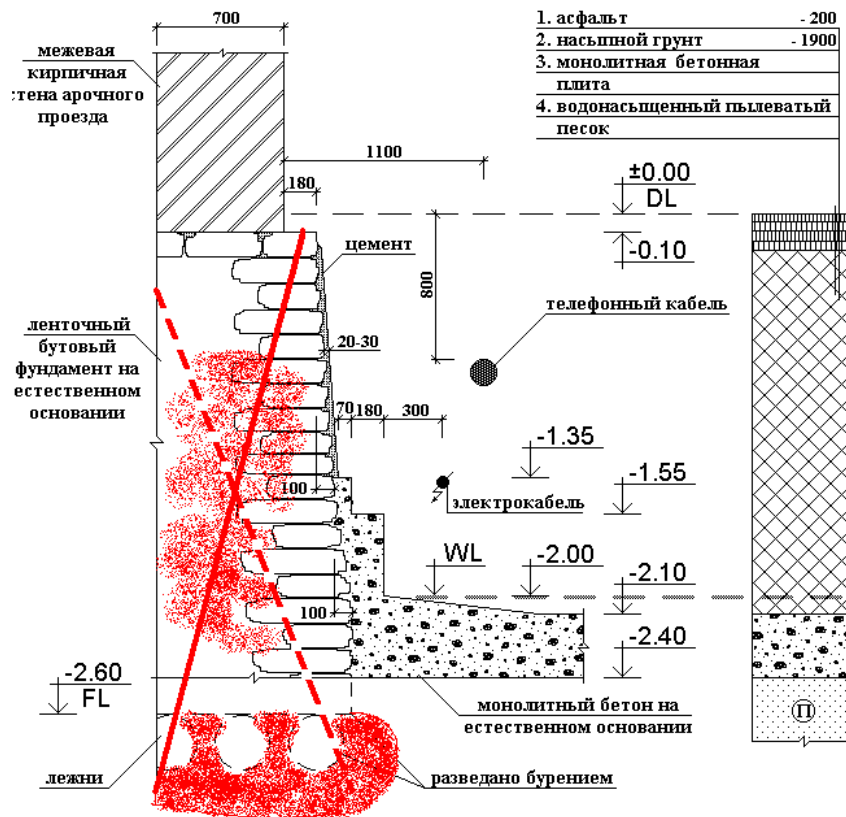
Схема – этап проведения комплекса инъекционных работ по усилению тела бутового фундамента и контактной зоны под его подошвой
